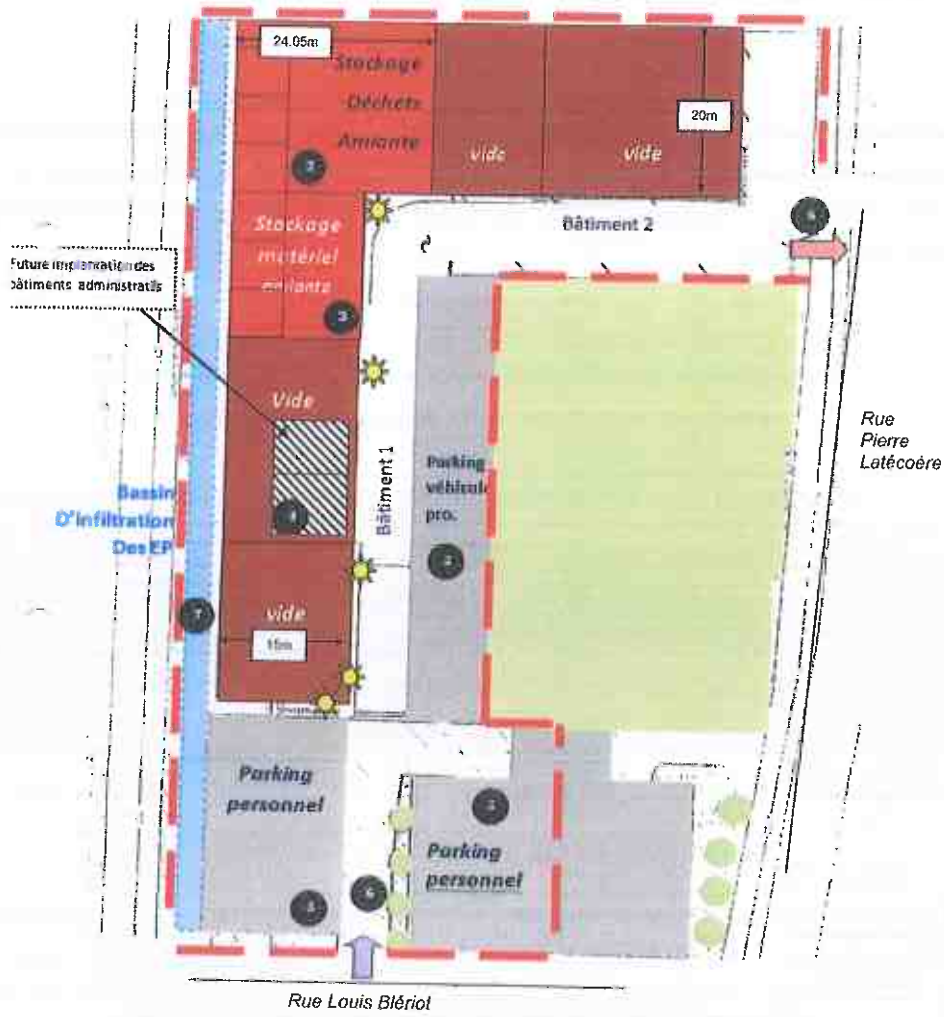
Plan d'implantation des installations sur le site MANNAMIANTE France
